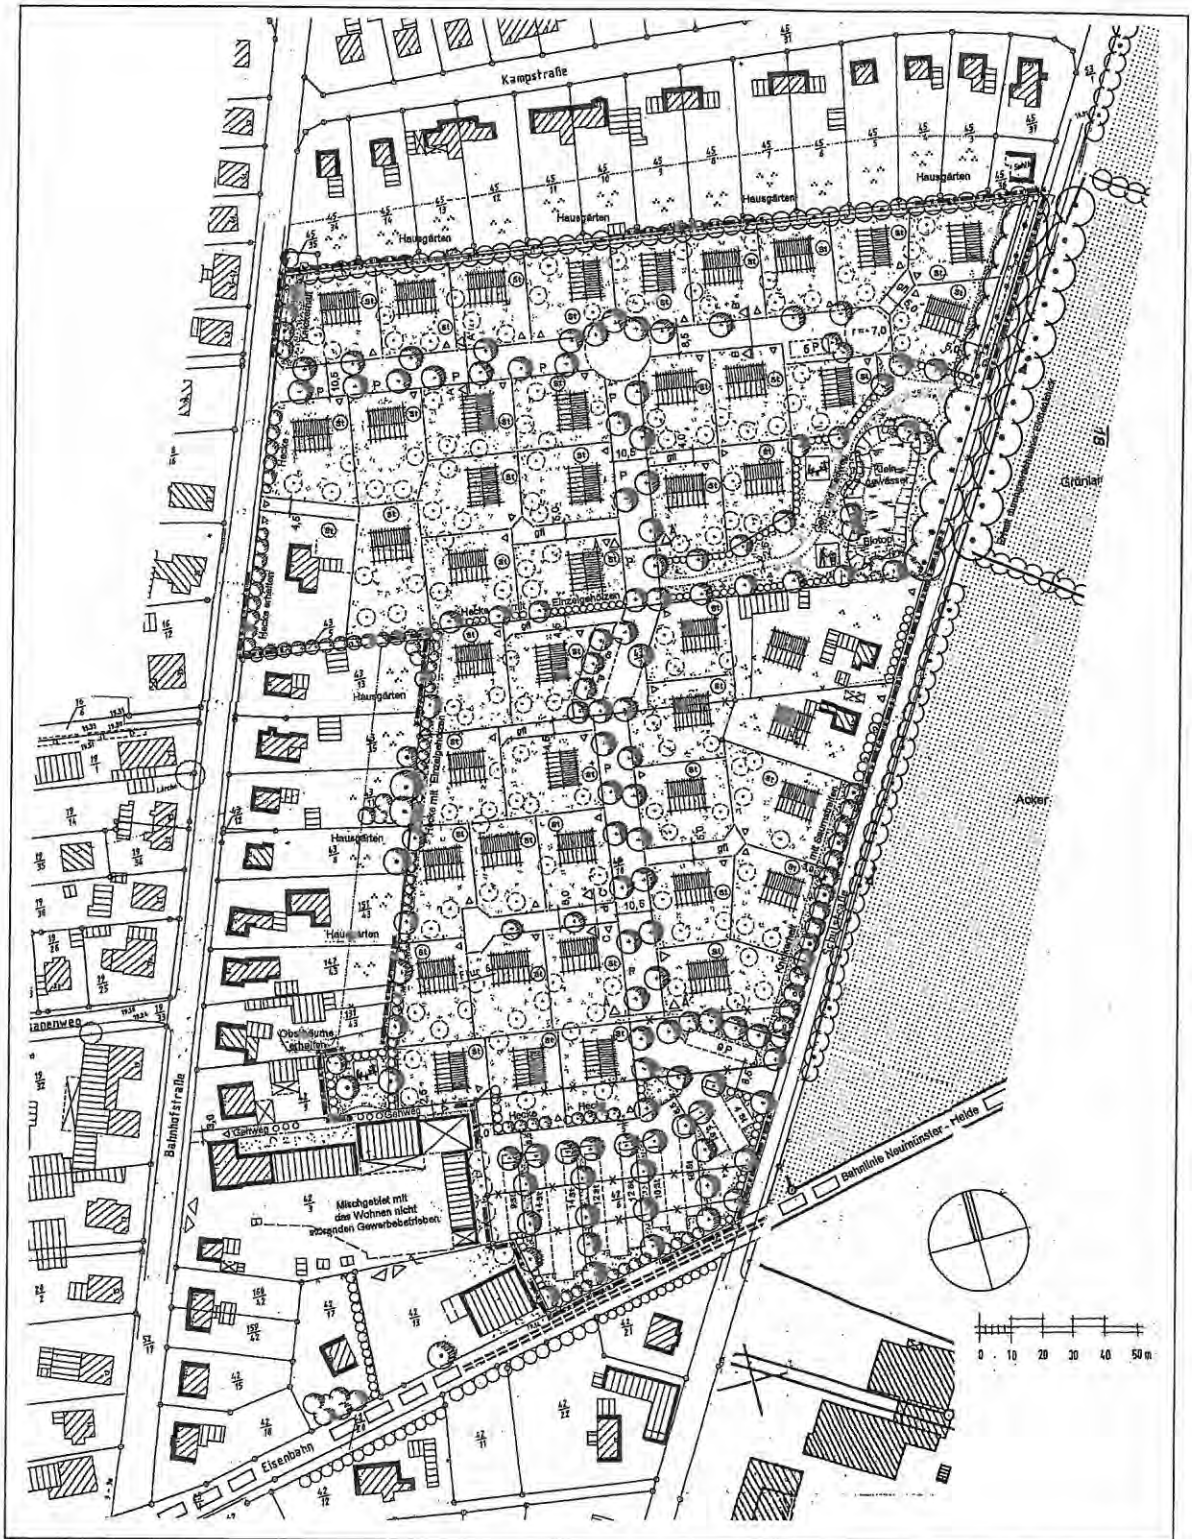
Planausschnitt aus „Städtebauliches Konzept mit integrierter Grünordnungsplanung“, Entwurf 5b, unmaßstäblich
